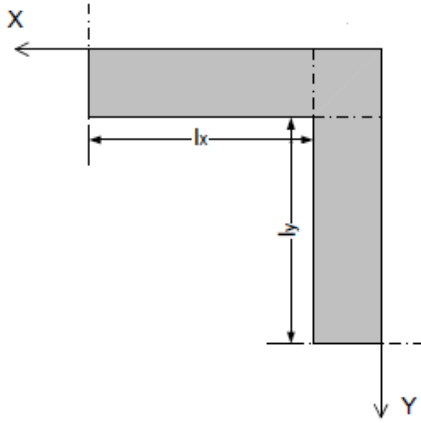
Corte no plano XY; fonte: EN ISO 10211.
